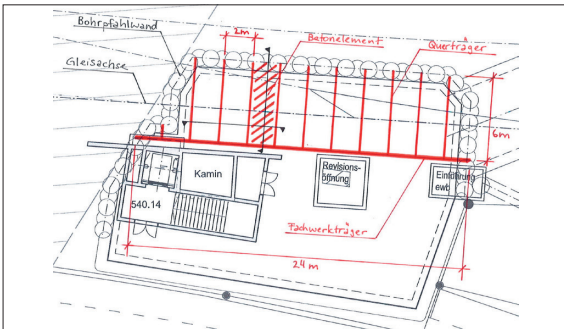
Grundriss der Baugrube mit Brücke
